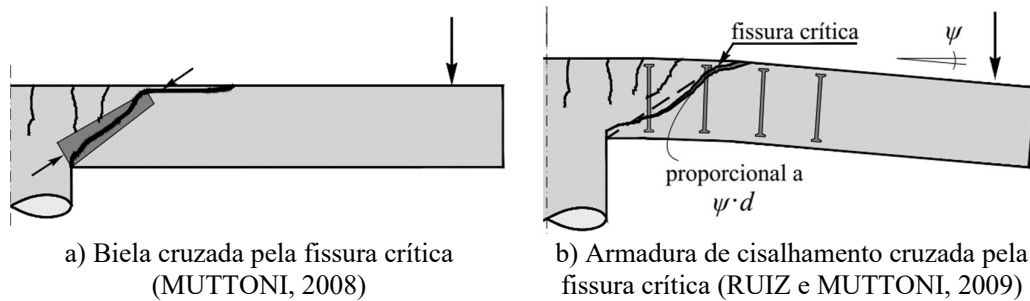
Teoria da Fissura Crítica de Cisalhamento.
